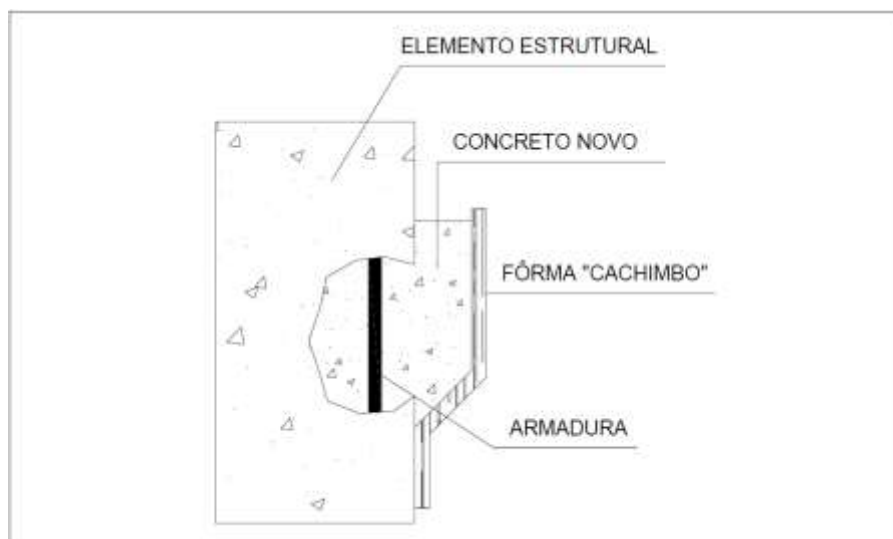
Detalhe da fôrma cachimbo (Fonte: SILVA, 2006)
